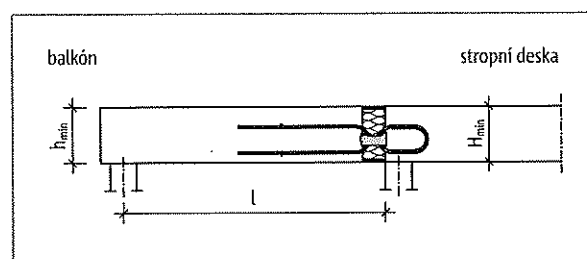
Schöck Isokorb® T typ QP-V7 a QP-V9: Statický systém
